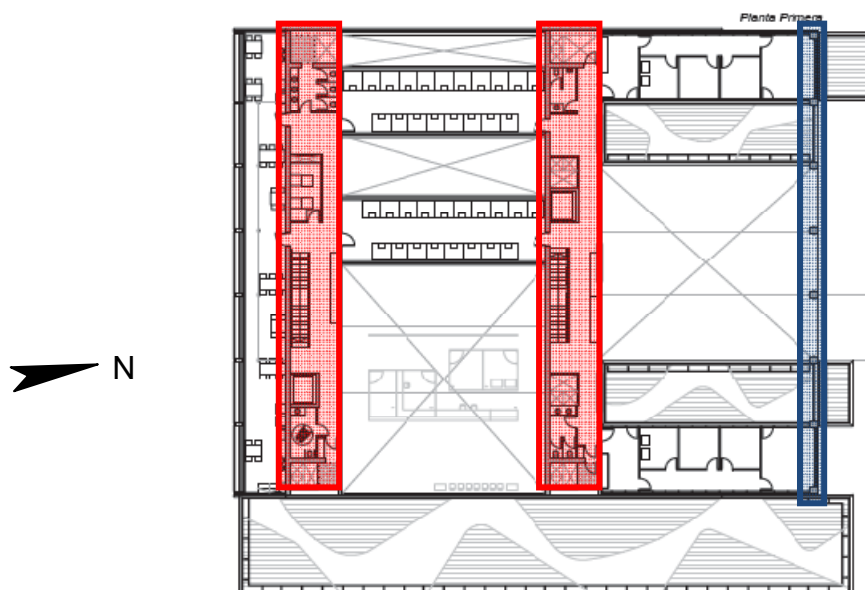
Planta Primera. Núcleos principales (rojos) y sistema porticado (azul)
